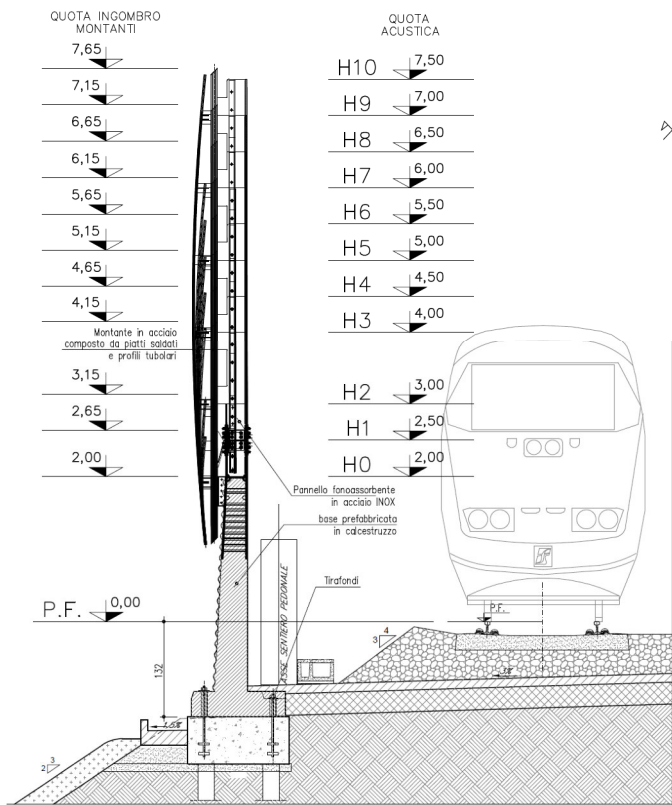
sezione bordo rilevato – Barriera verticalizzata
